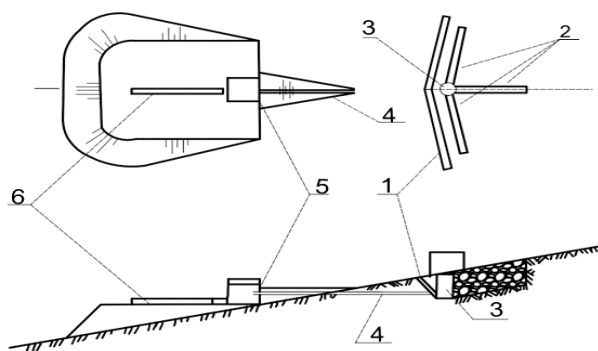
Проектная схема пилотного участка грунтового водохранилища
